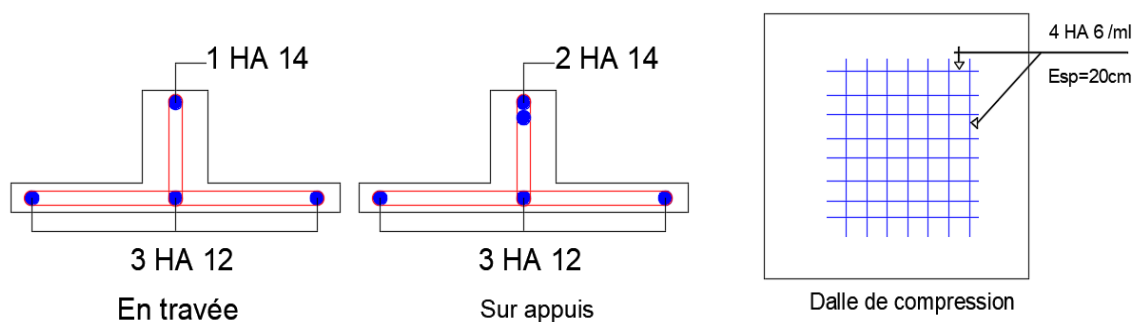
Plan de ferrailage des poutrelles et dalle de compression
